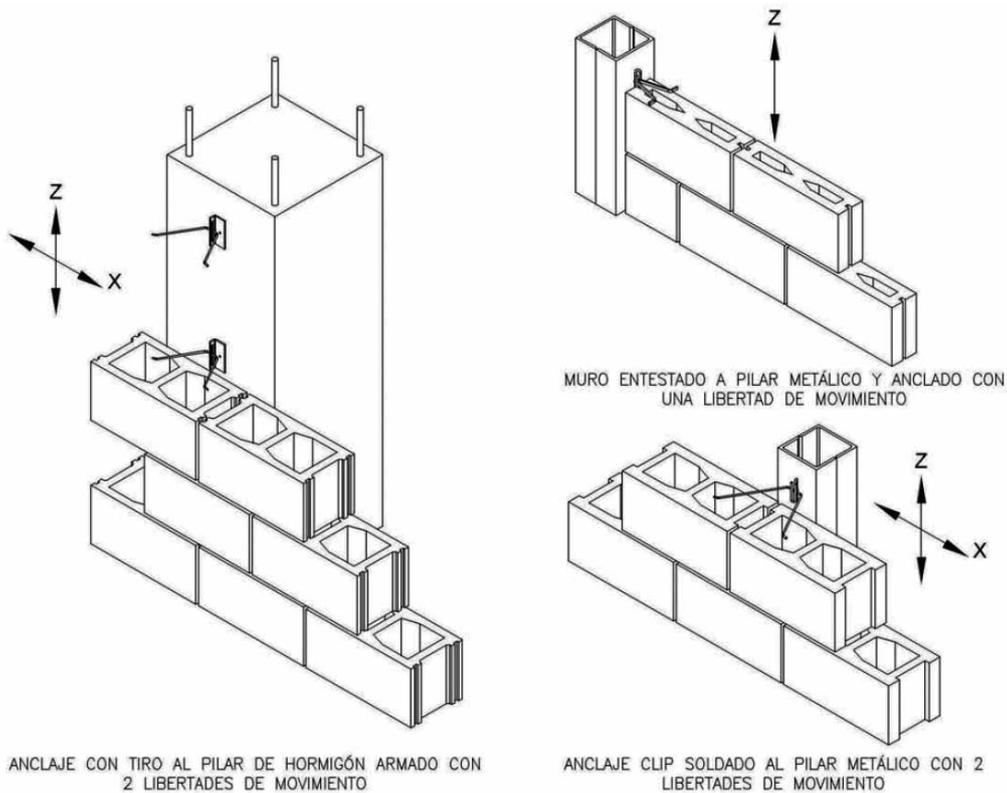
Anclajes a pilares con 1 ó 2 libertades de movimiento del plano del muro.
